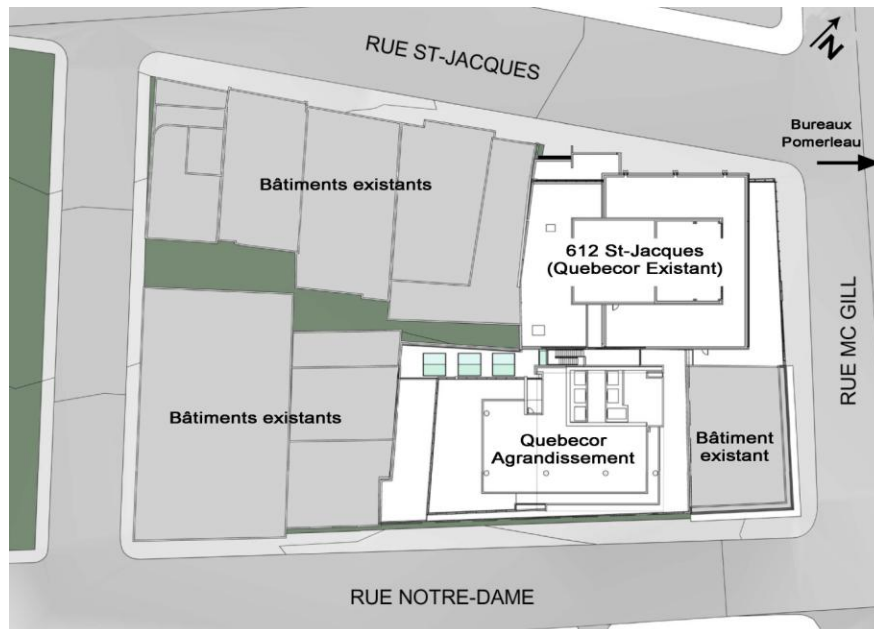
Plan d'implantation (Source: ARC/CH, 2006)
